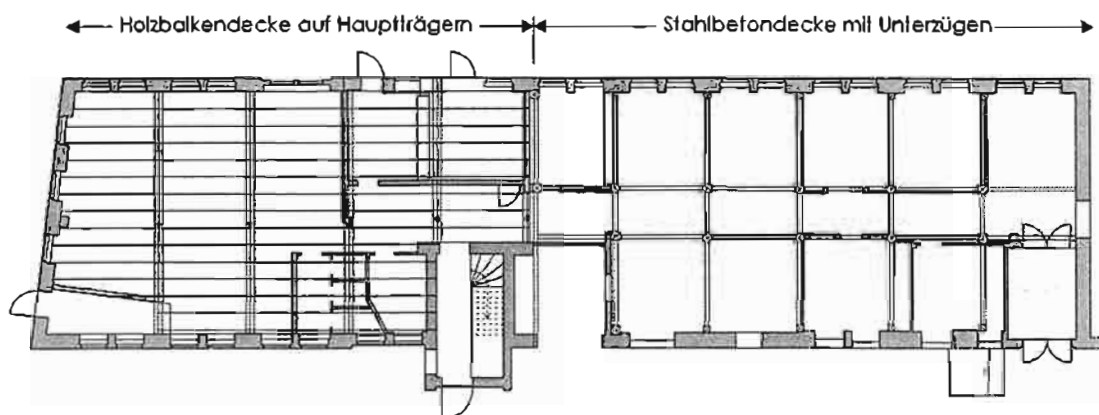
unterschiedliche Deckentypen über dem Erdgeschoss
